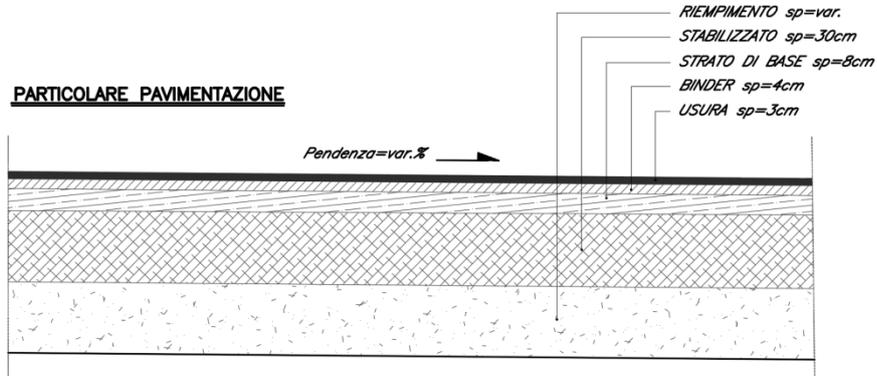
Pacchetto di pavimentazione Sublotto
